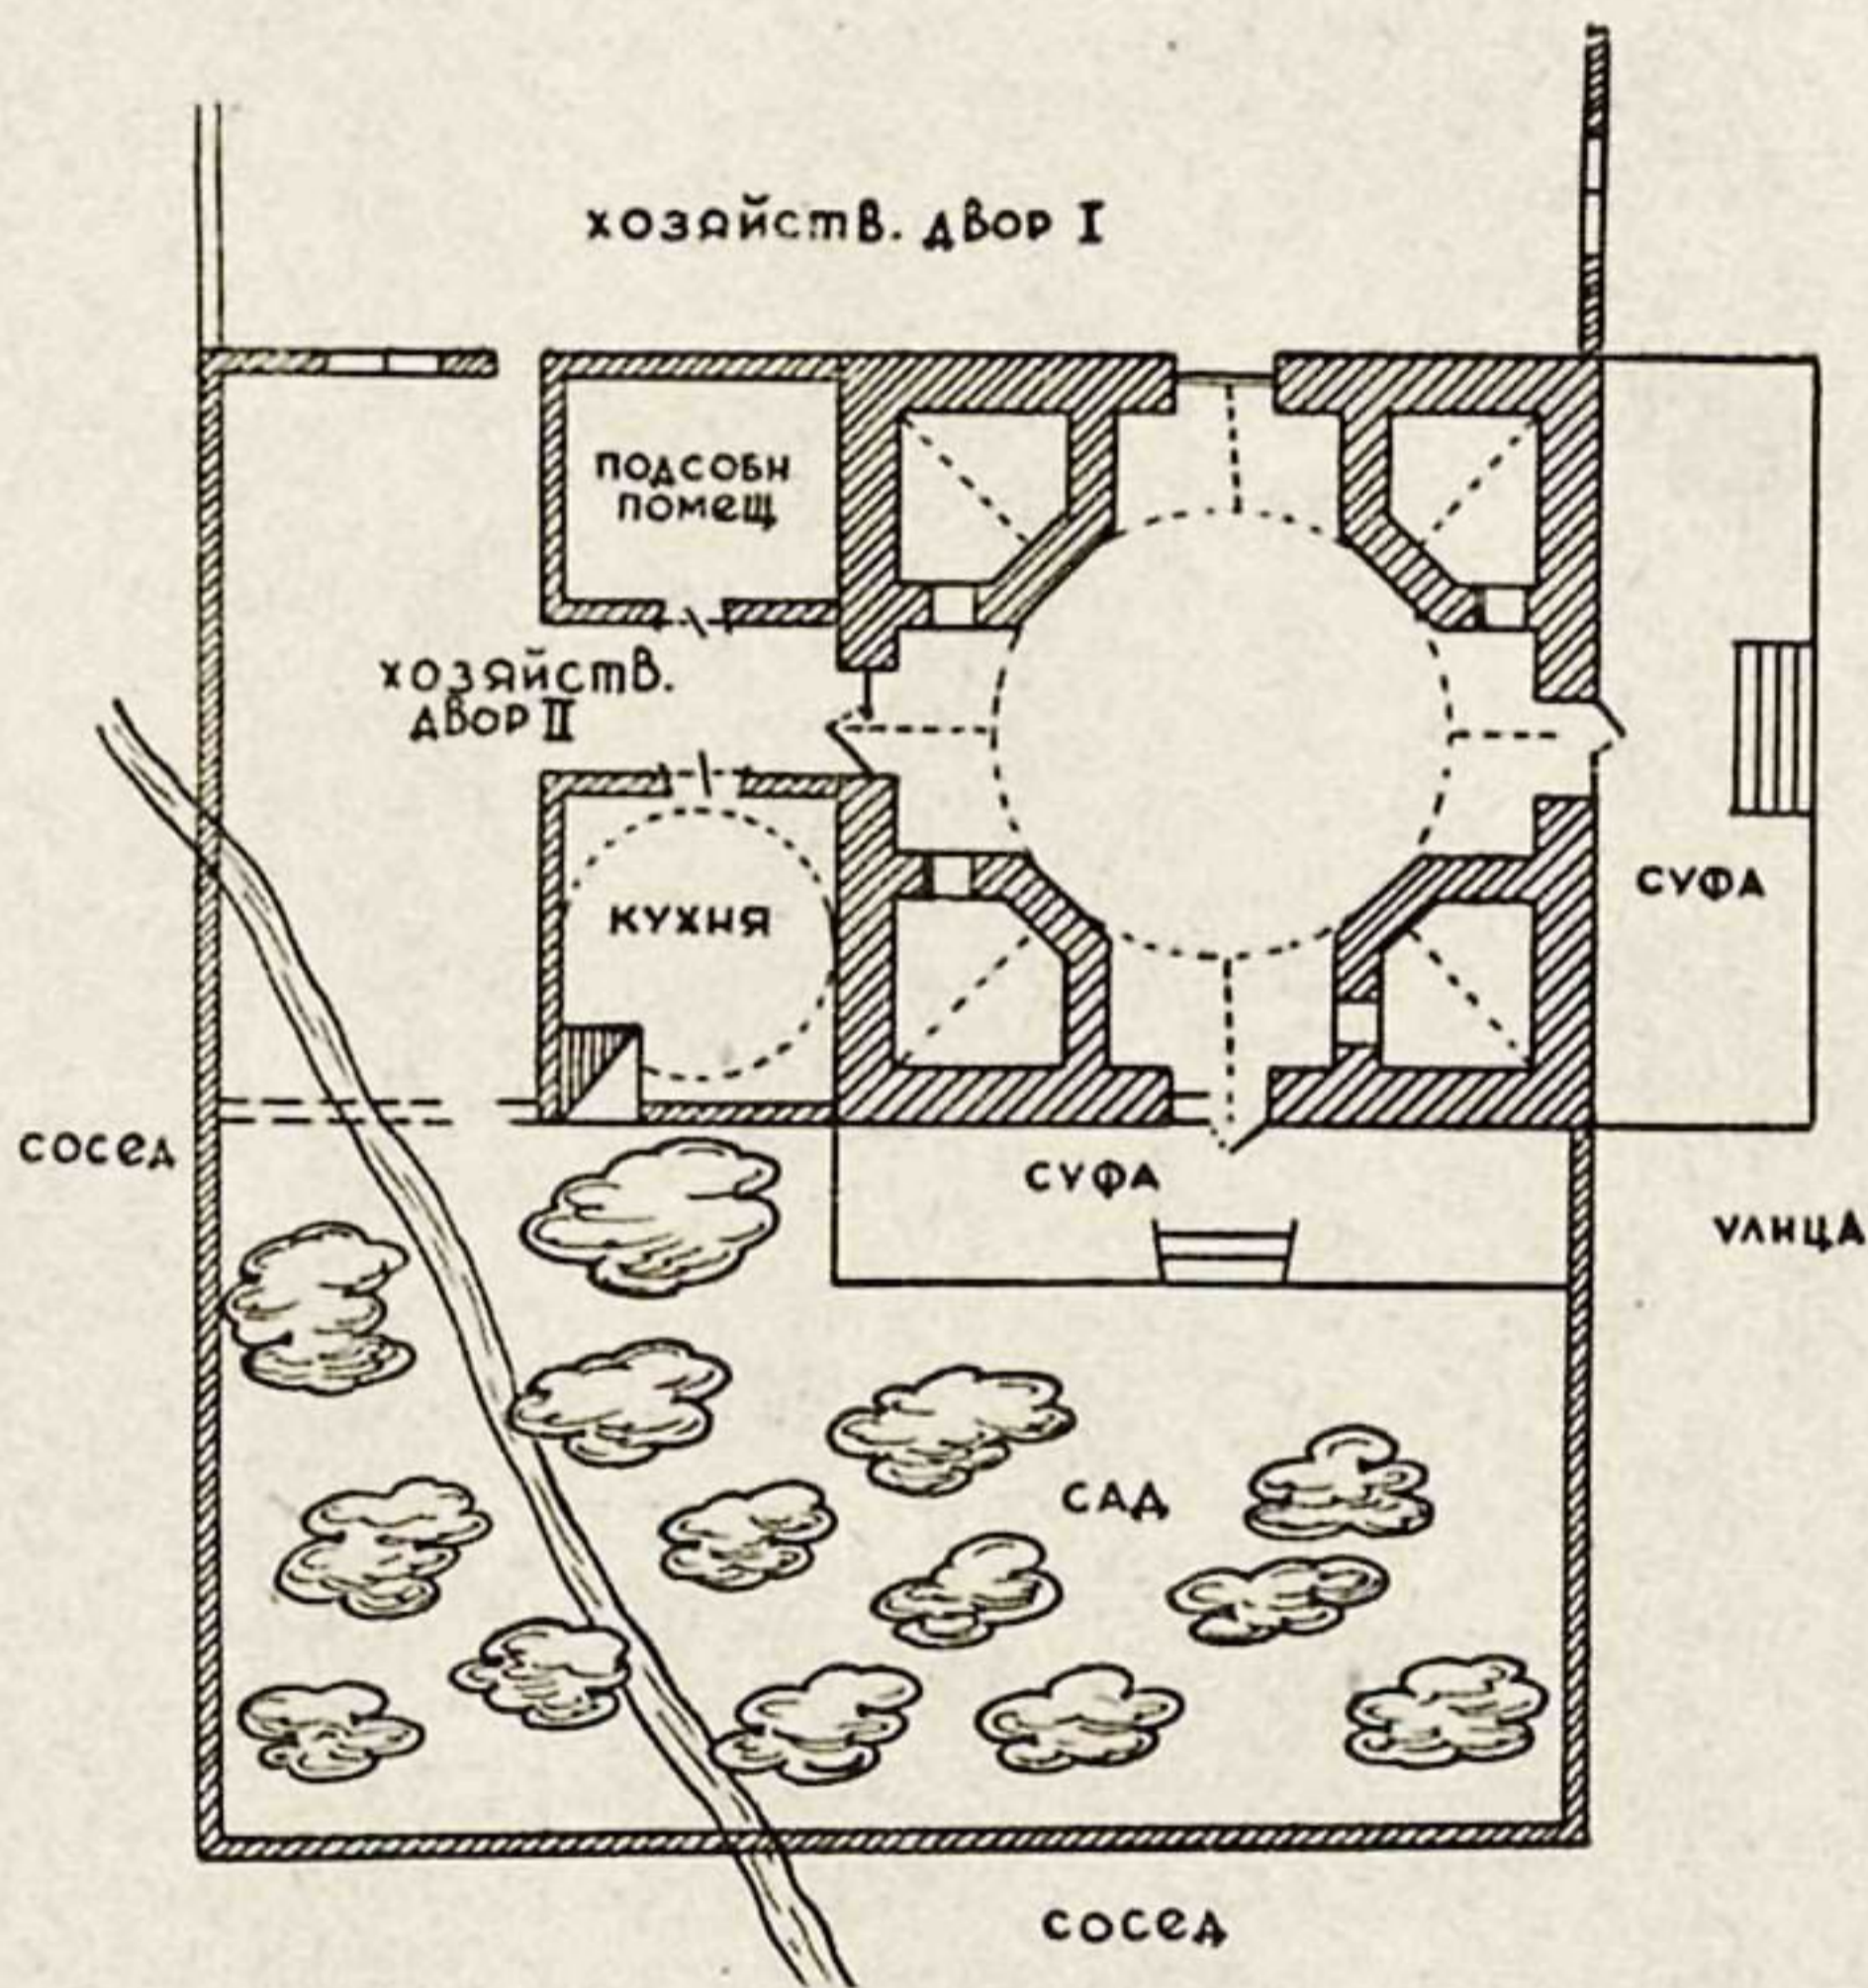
Опыт реконструкции плана усадьбы и сырцового жилого дома в Древнем Термезе
